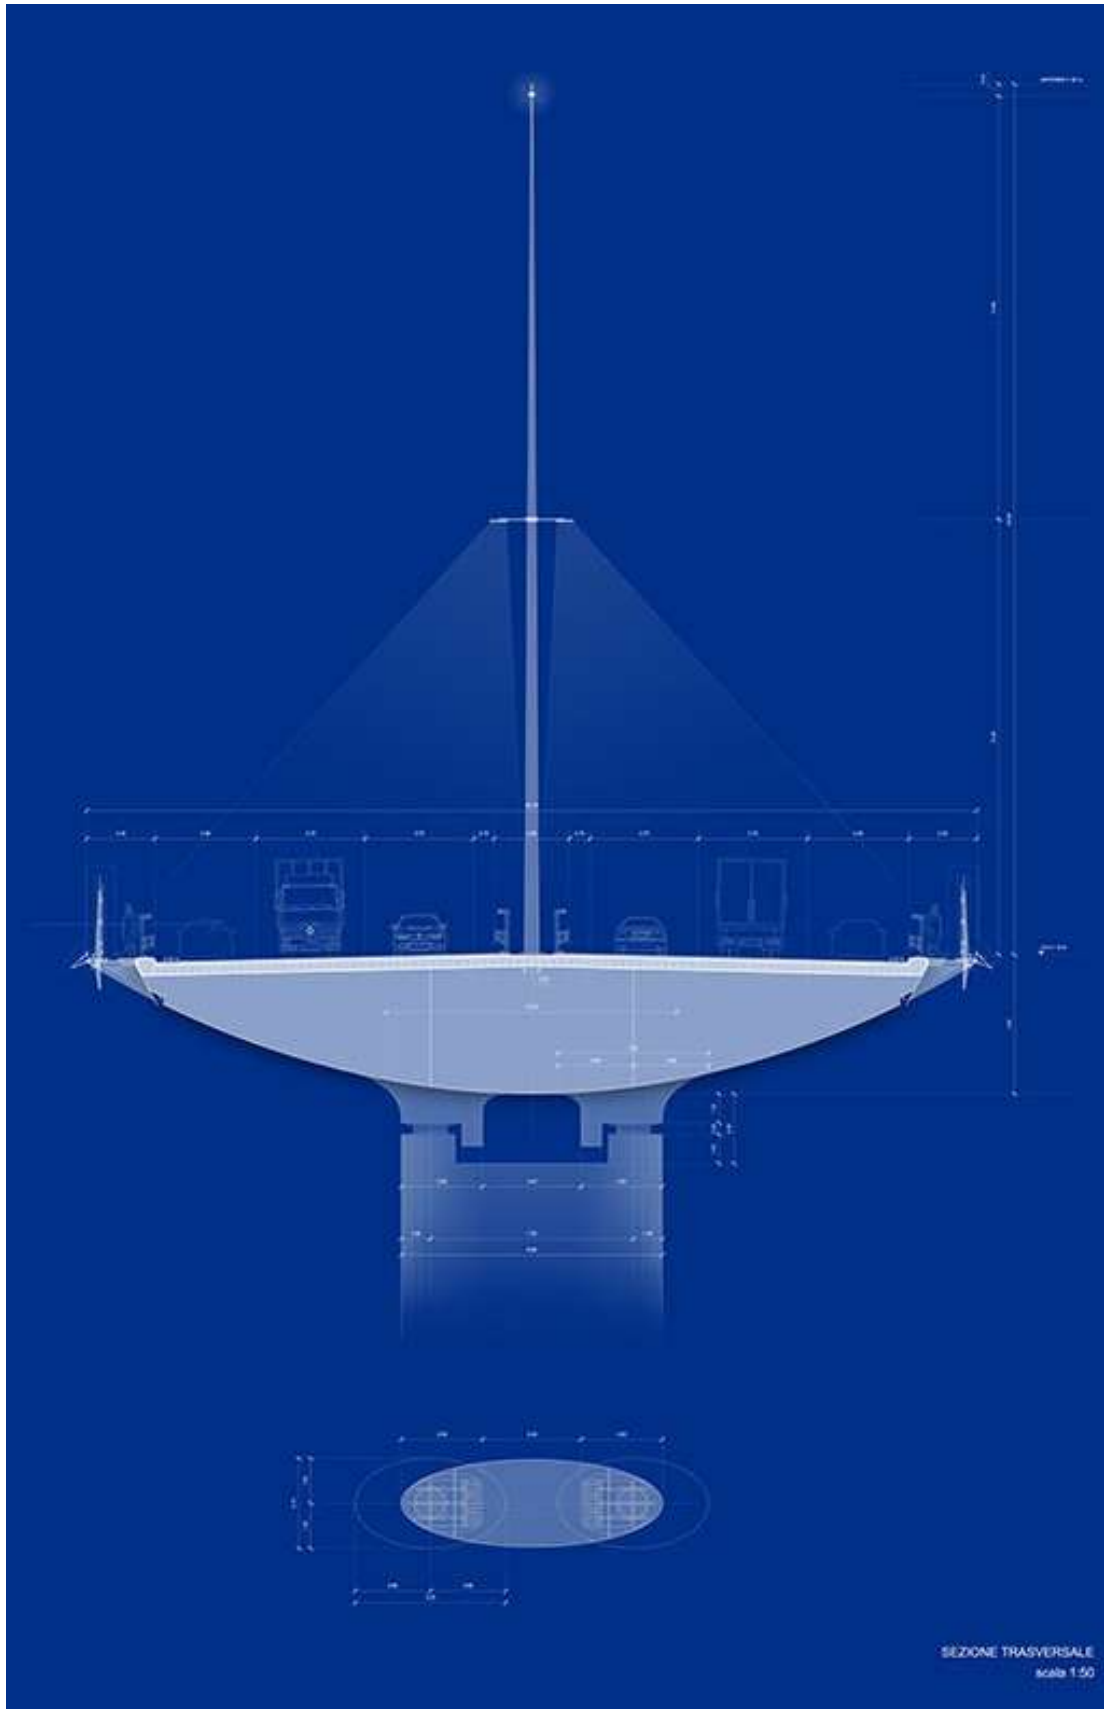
Corte transversal do pilar e do tabuleiro da Ponte San Giorgio. Fonte: Renzo Piano Building Workshop
